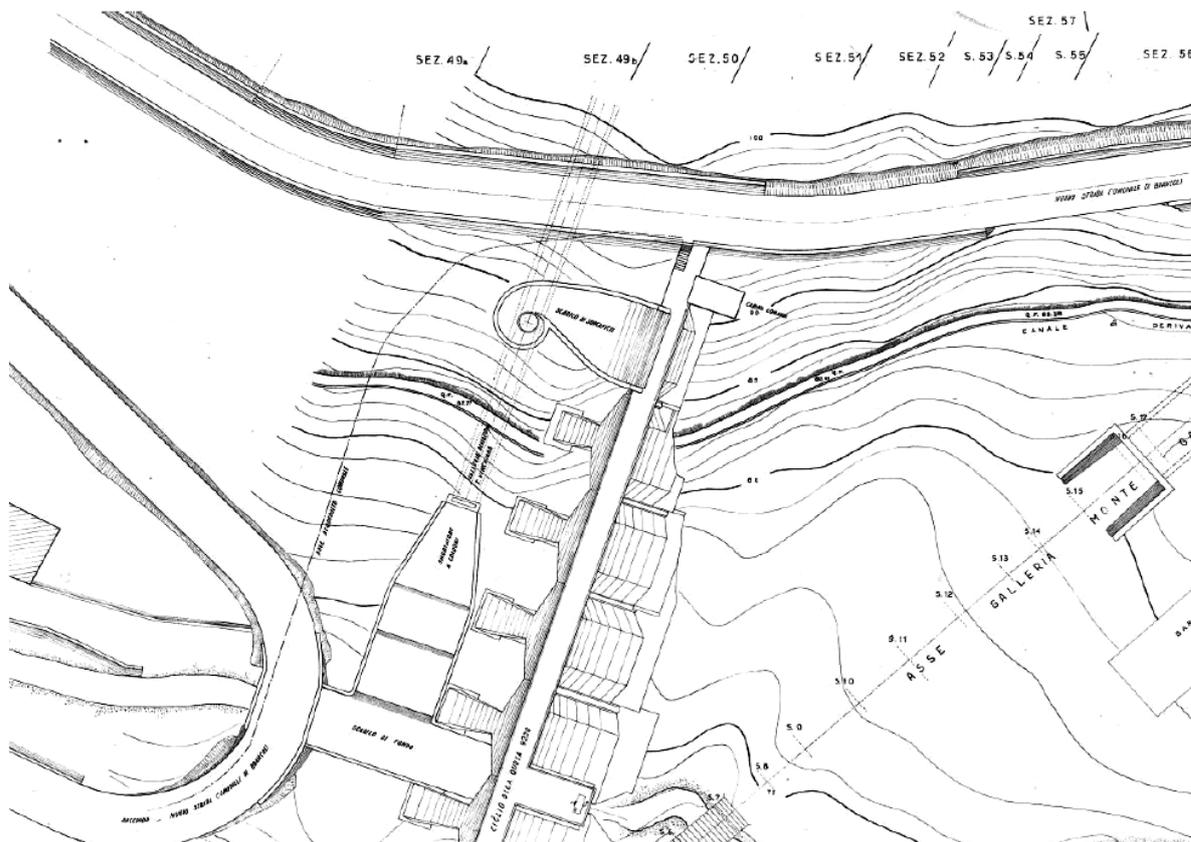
stralcio planimetrico del progetto della strada Brancoli
